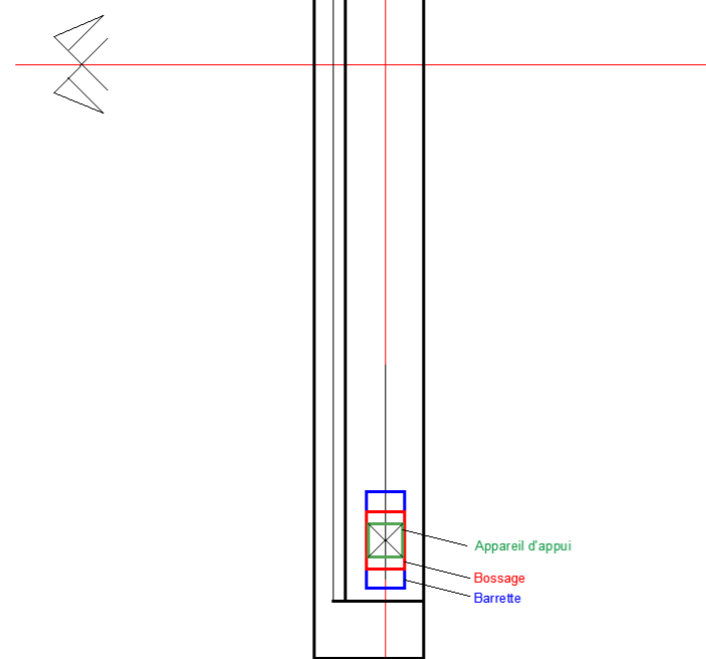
Piano di principio a metà vista per le spalle
